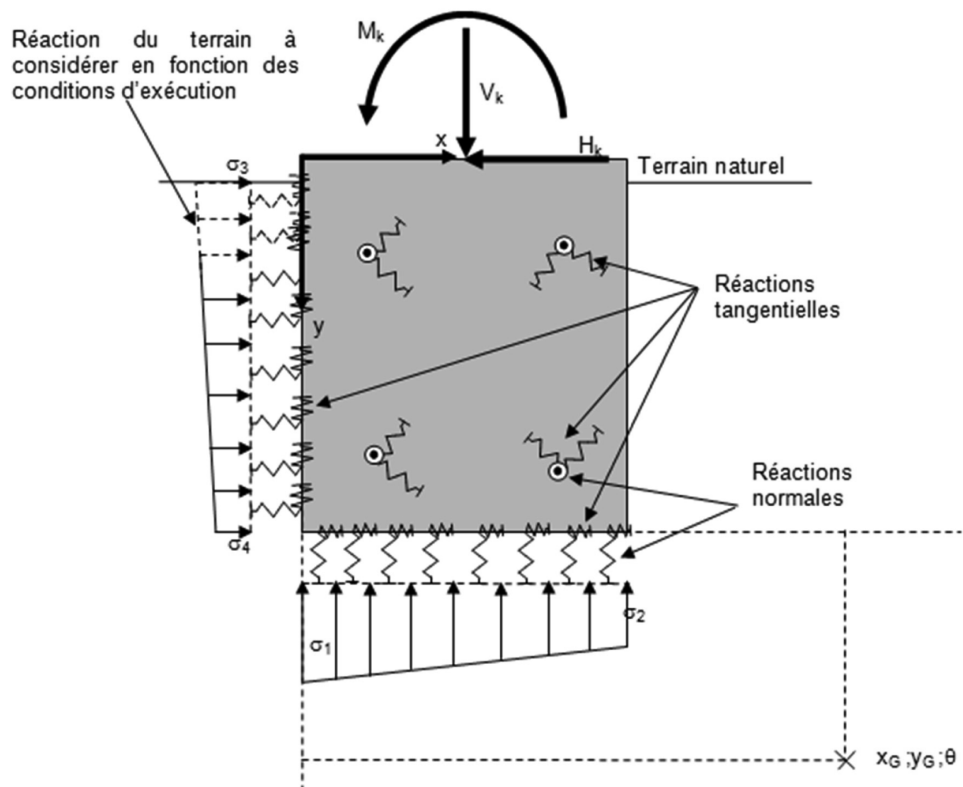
Schéma de calcul d'une fondation semi-profonde
